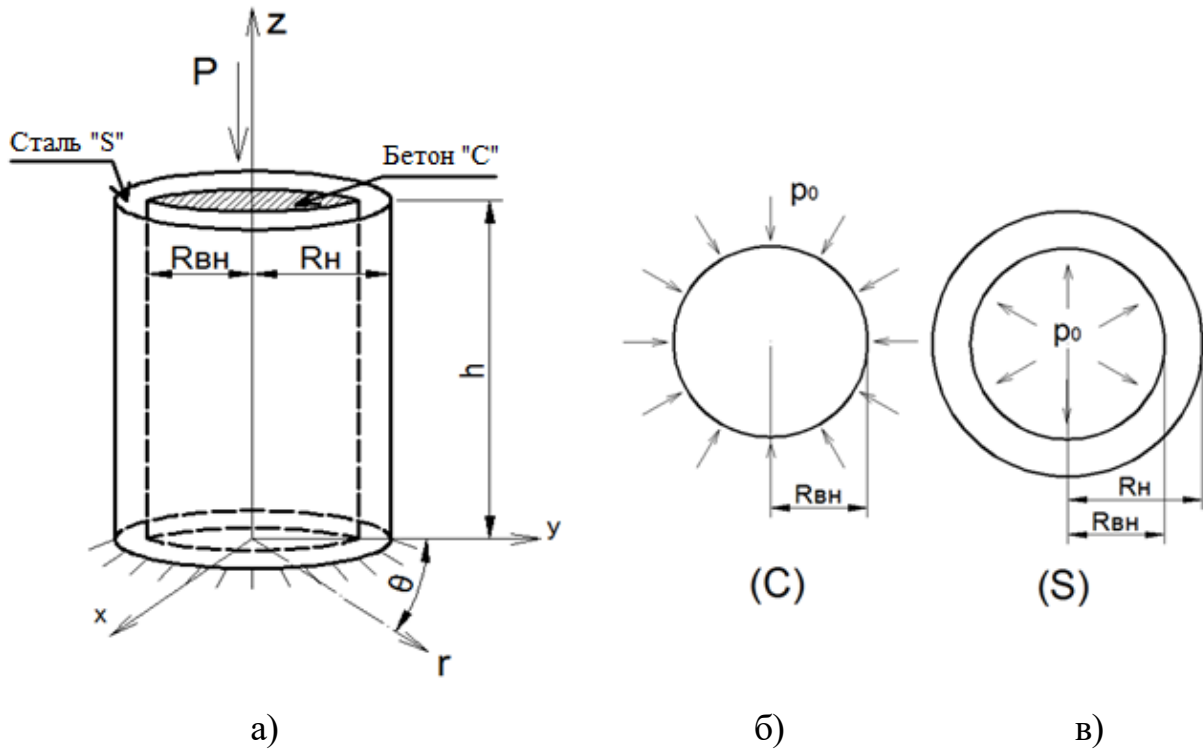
Расчетная схема трубобетонной стойки:
